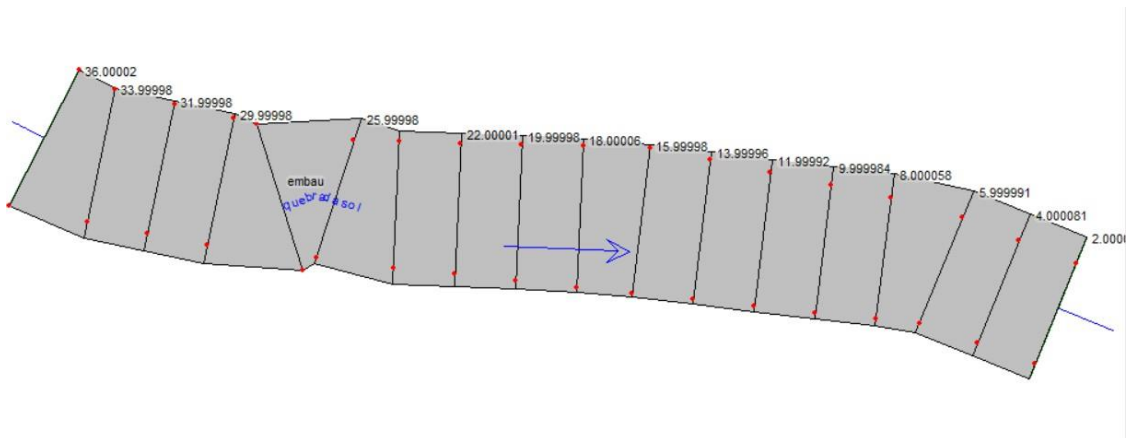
Perfil del canal tipo baúl bajo el puente 13 de julio.
